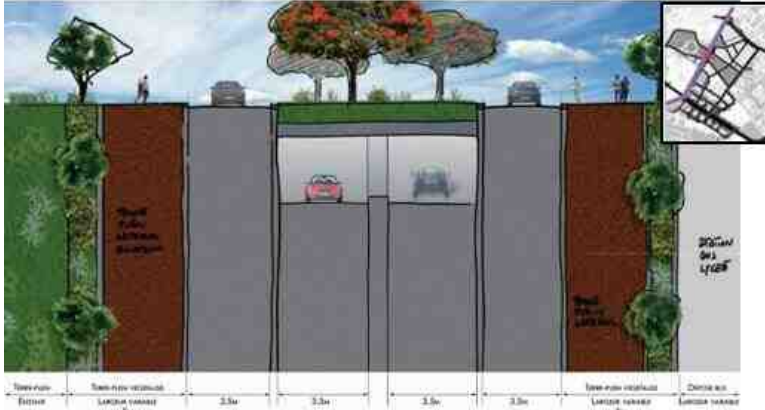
Profil en travers proposé pour la RN4a au droit du Parc Boisé existant
